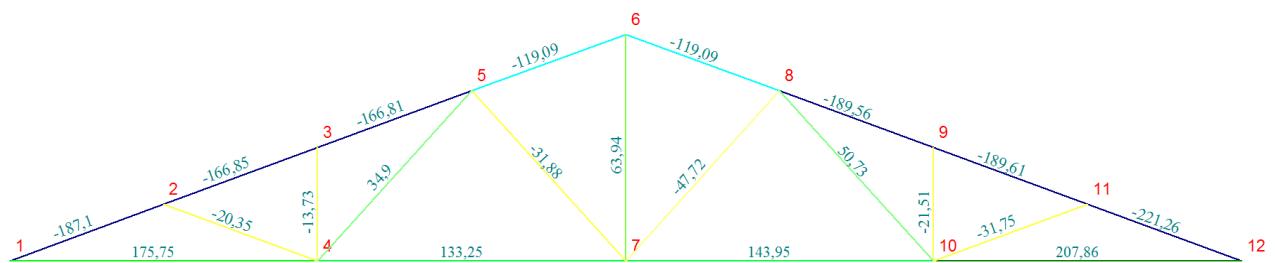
Расчетные усилия в элементах ферма (в кН).
